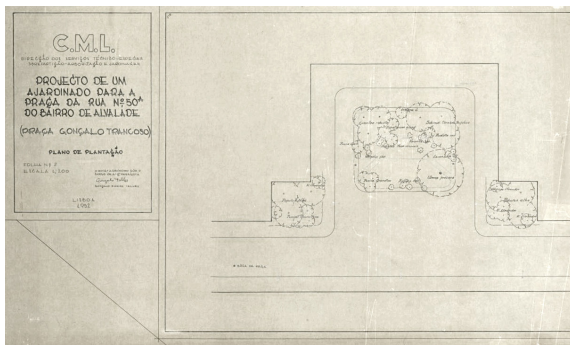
Projeto de um ajardinado para a Praça da Rua nº 50 do Bairro de Alvalade (Praça Gonçalo Trancoso). Plano de plantação. Ribeiro Telles, 1952.
